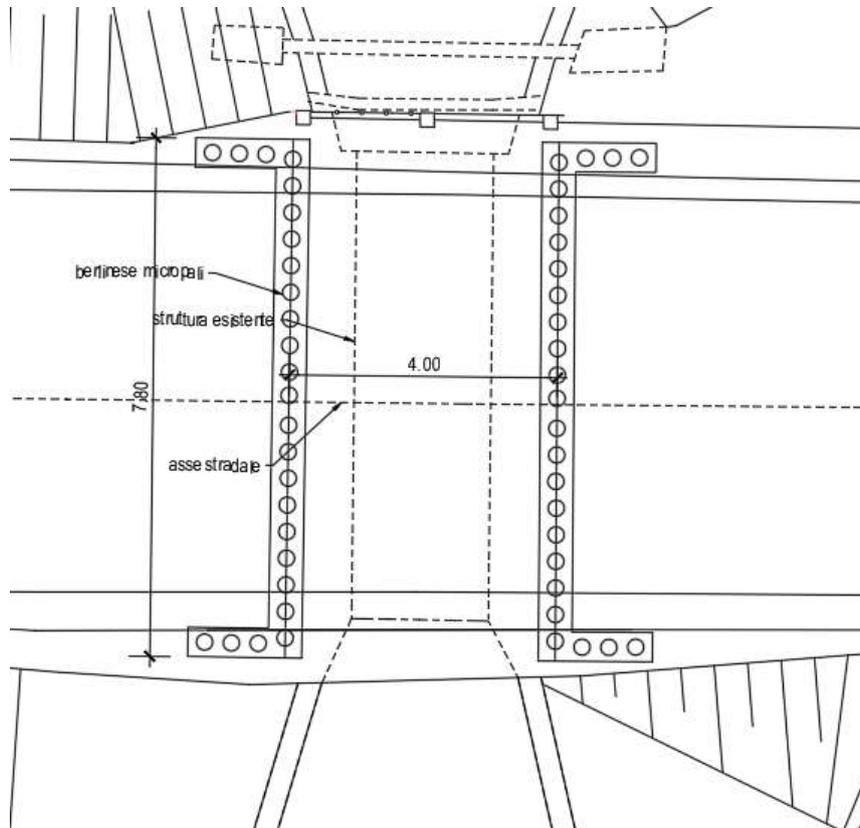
Planimetria sistemazione di progetto al km 58+700
